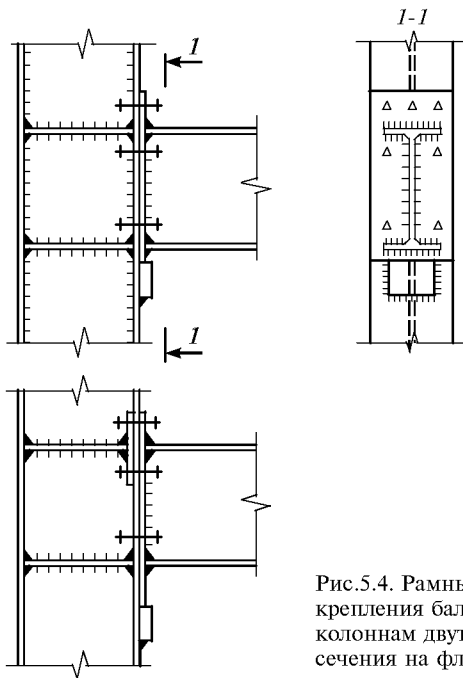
Рамный узел крепления балок к колоннам двутаврового сечения на фланцах
